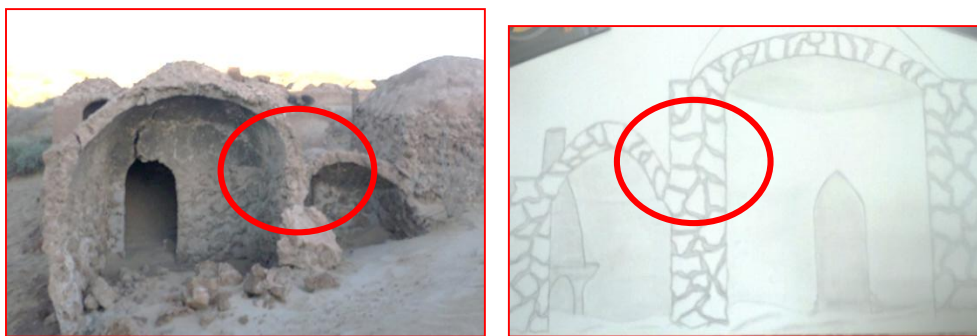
Relations des planchers avec les murs (Source : Auteur / 2017)
